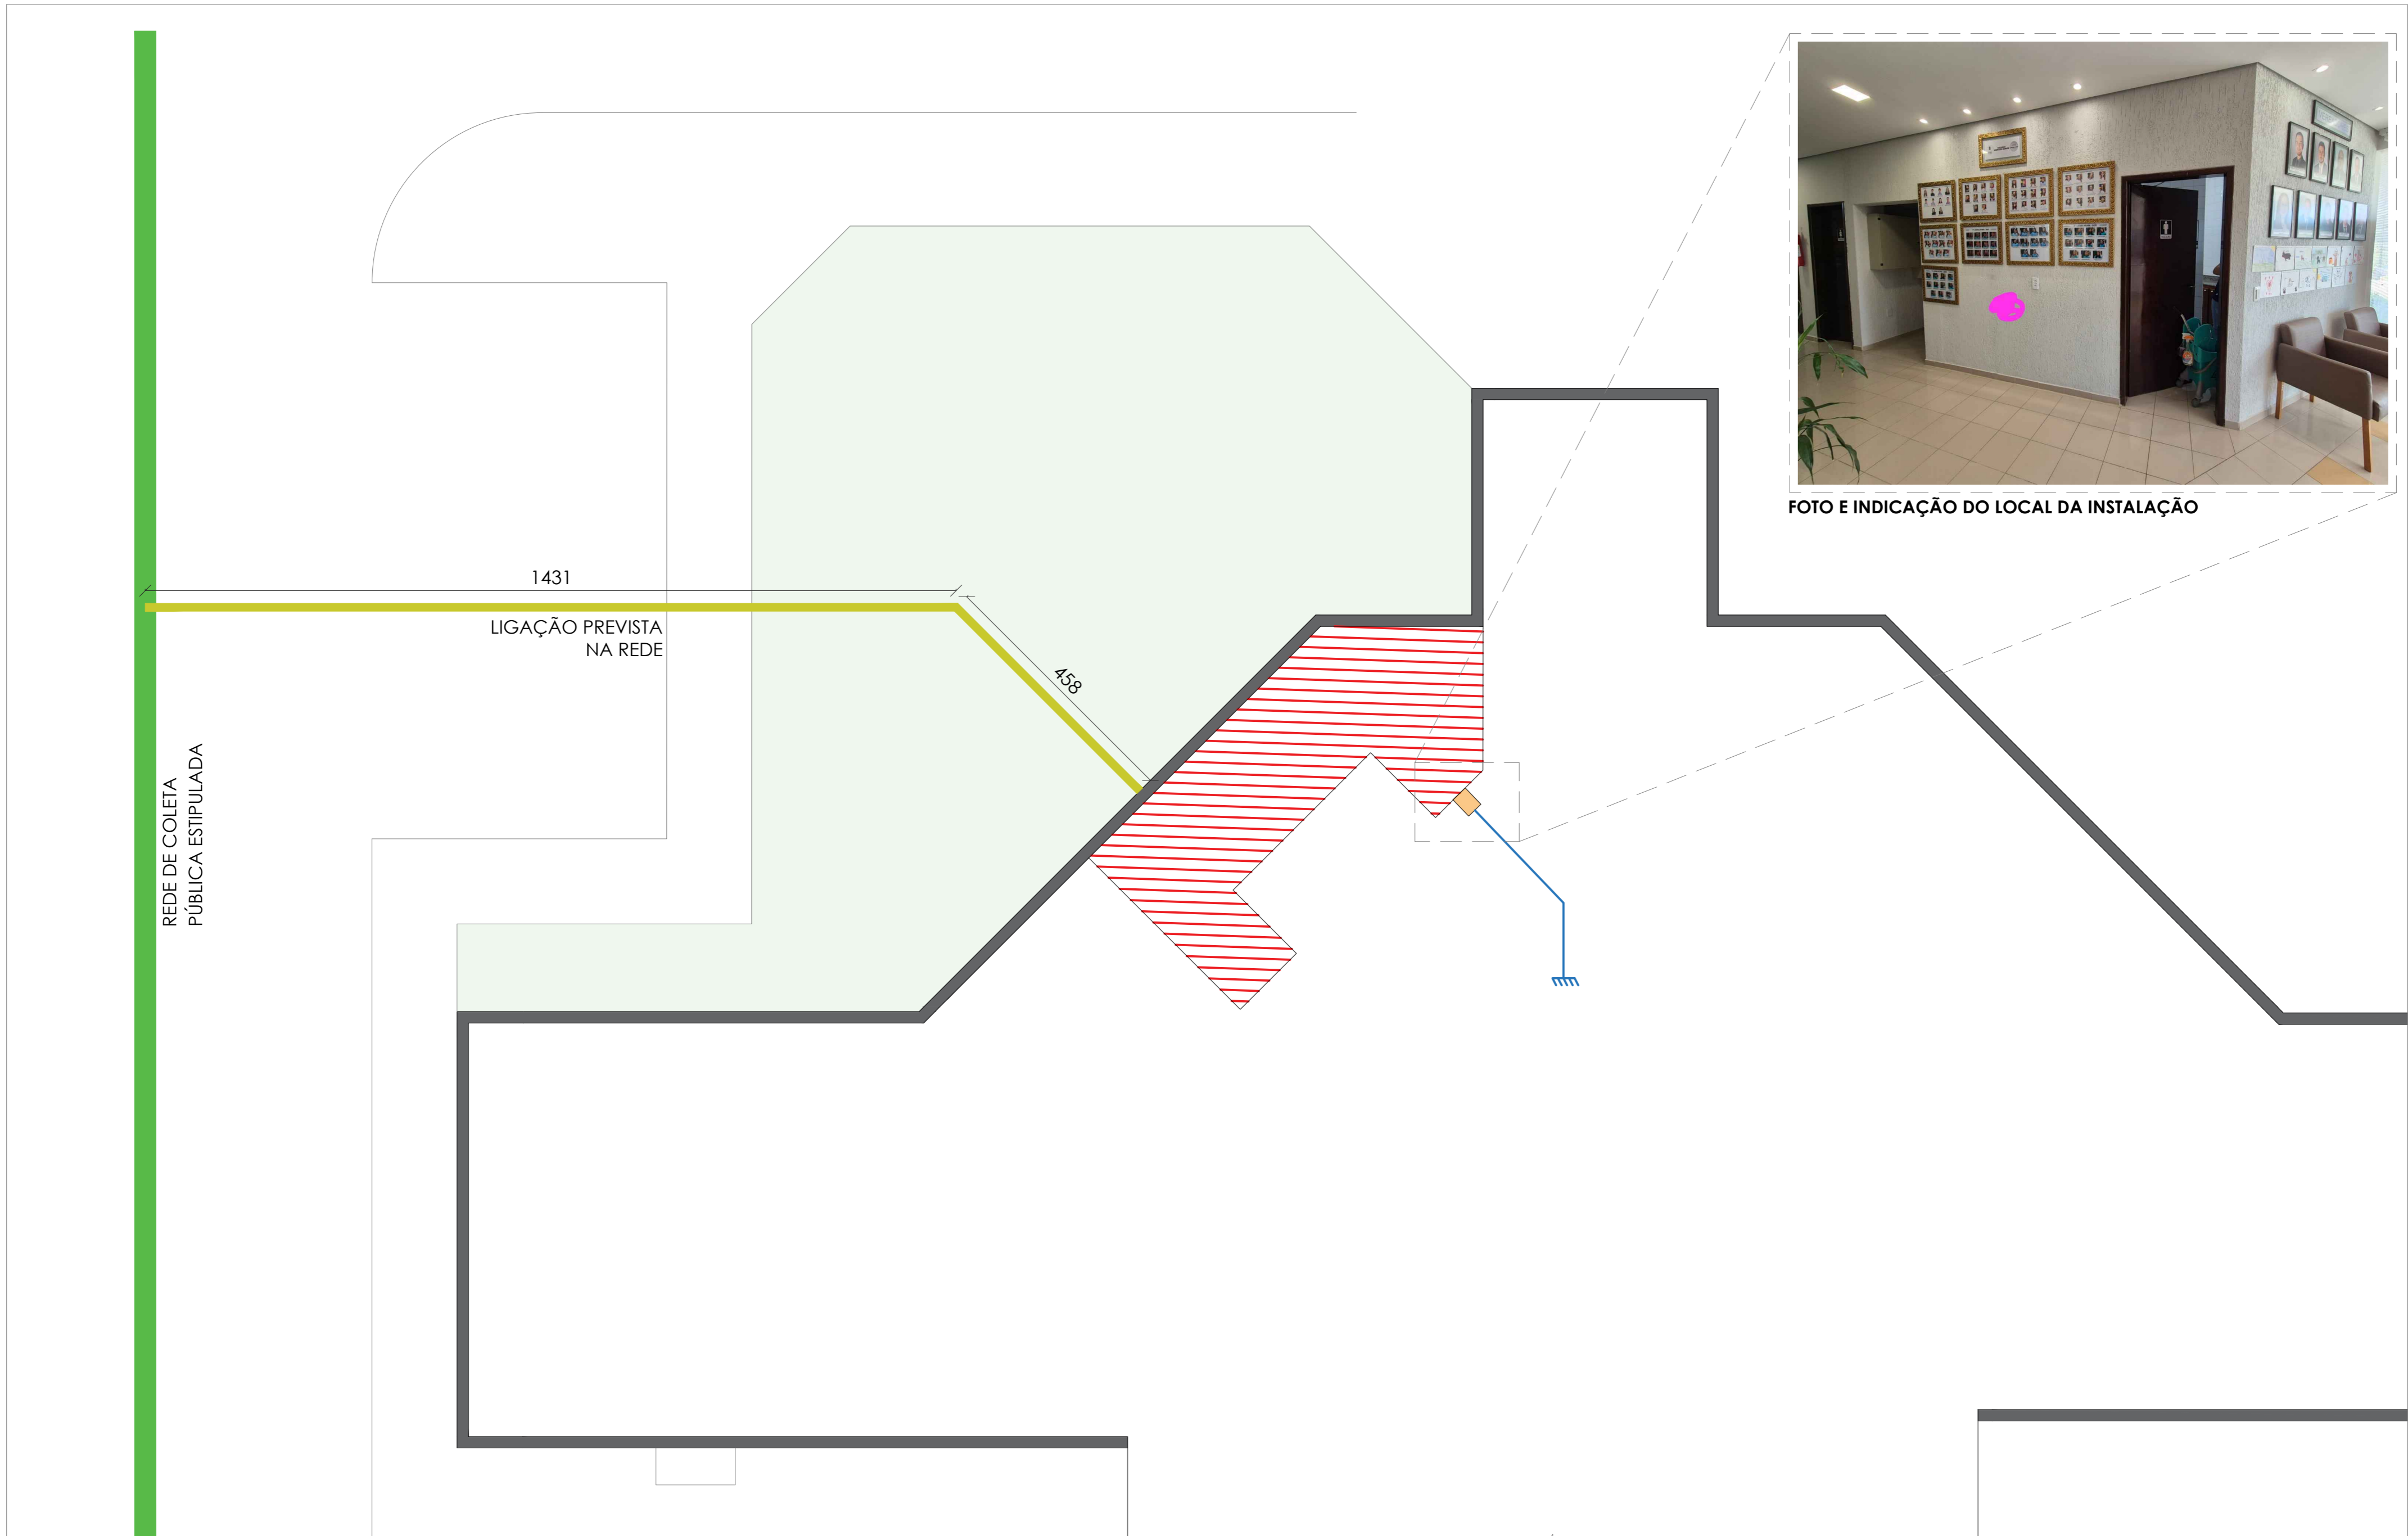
FOTO E INDICAÇÃO DO LOCAL DA INSTALAÇÃO
